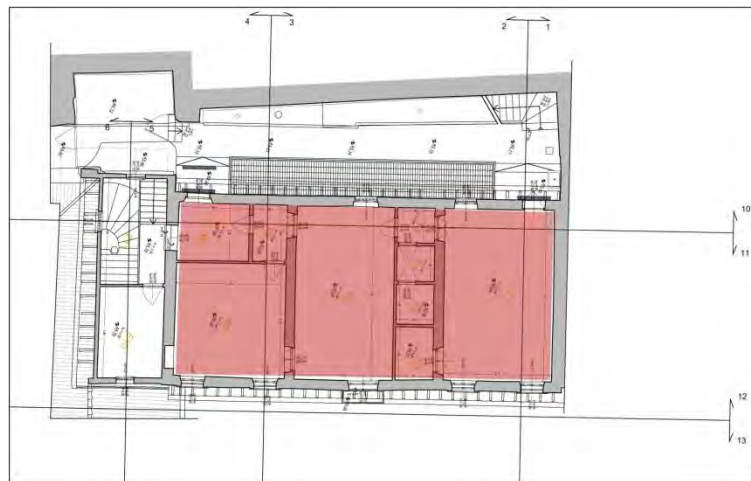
2 - pianta livello IV - localizzazione U.S.
